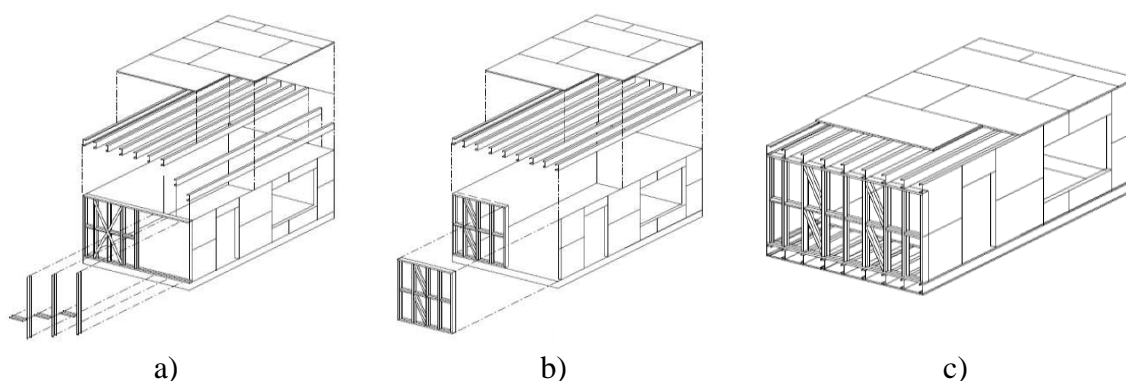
Representação esquemática da construção: a) “*Stick-build*”; b) Por painéis; c) Modular (Ferreira, 2014).
